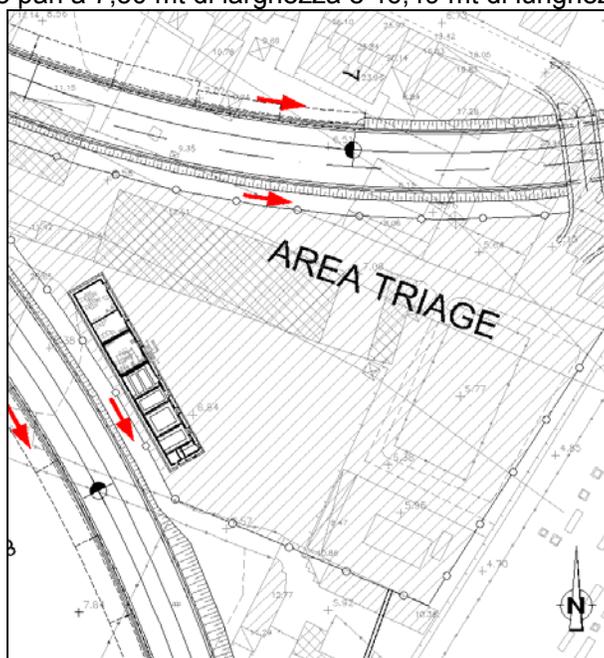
stralcio planimetrico ubicazione fabbricato tecnologico
